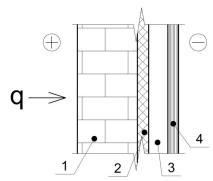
Схема конструкции наружной стены: 1 – кладка из стеновых камней; 2 – экранная изоляция; 3 – воздушная прослойка; 4 – облицовочный слой
